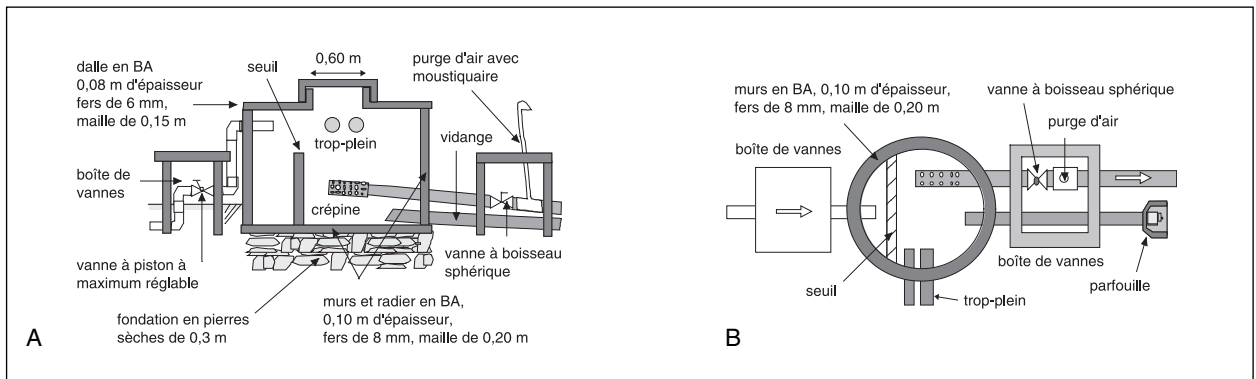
Bassin brise-charge en béton armé. A, vue en coupe. B, vue en plan.
